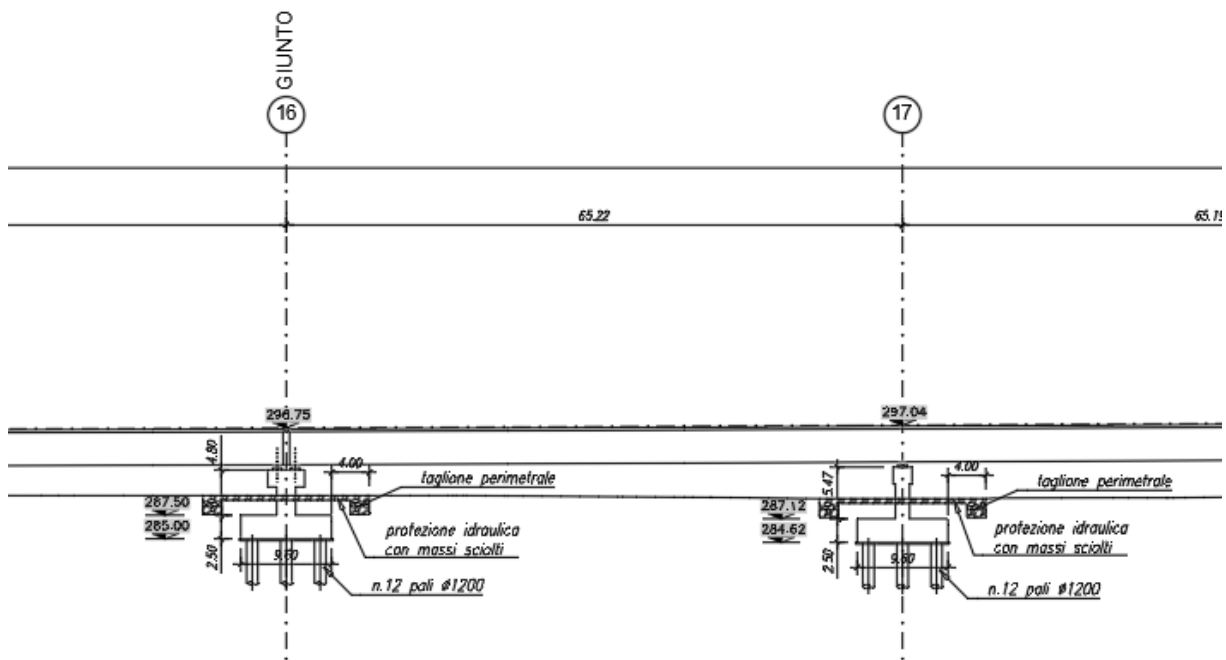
Esempio di pile di transizione con giunto strutturale e stradale
